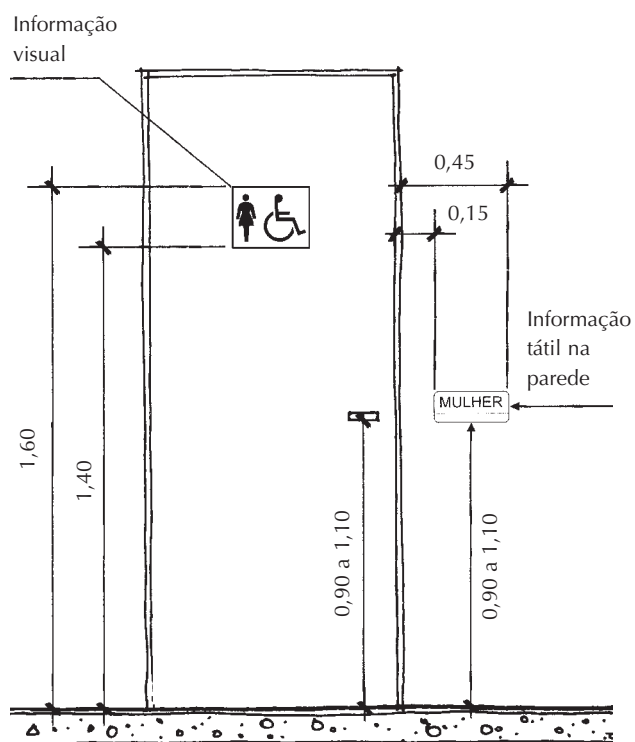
Vista frontal externa da porta de um sanitário adaptado
